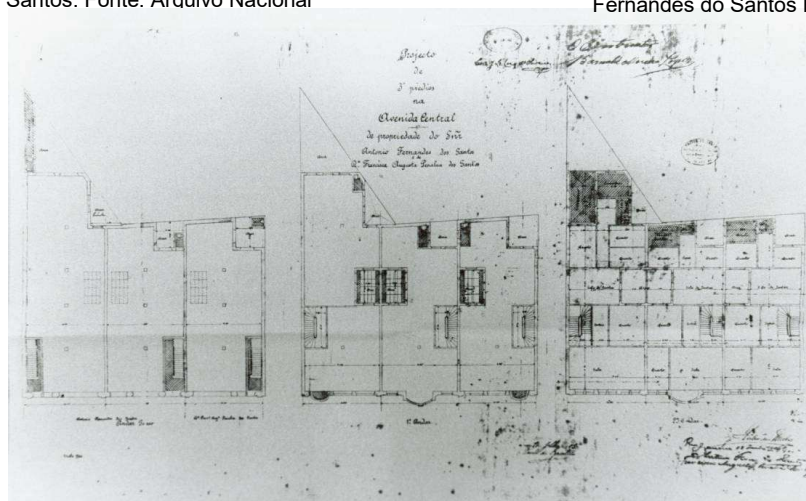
Planta baixa 1º, 2º e 3º pavimentos do Edifício Antônio Fernandes dos Santos. Fonte: Arquivo Nacional
